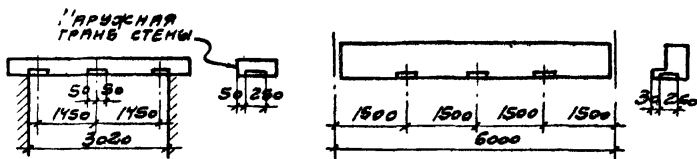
СХЕМА ЗАКЛАДНЫХ ЭЛЕМЕНТОВ В ЖЕЛЕЗОБЕТОННЫХ ПЕРЕМЫЧКАХ И ОБВЯЗОЧНЫХ БАЛКАХ
